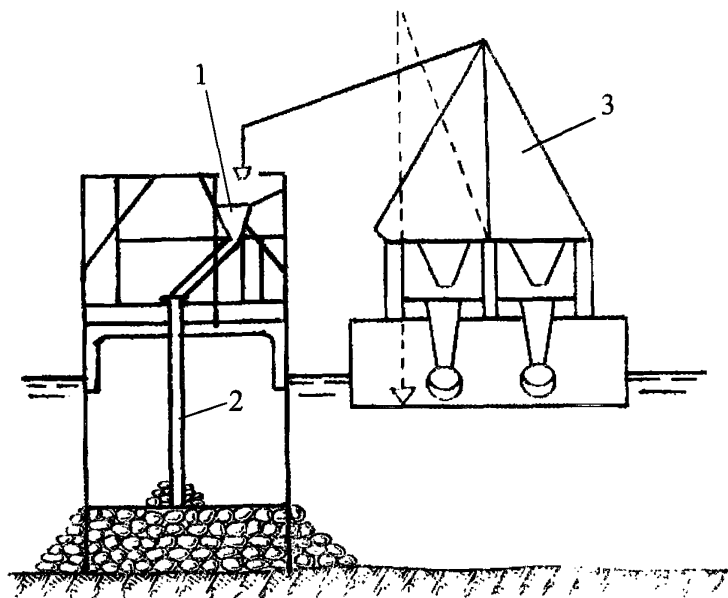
Схема подачи бетона по вертикально перемещающимся трубам (способ ВПТ):
